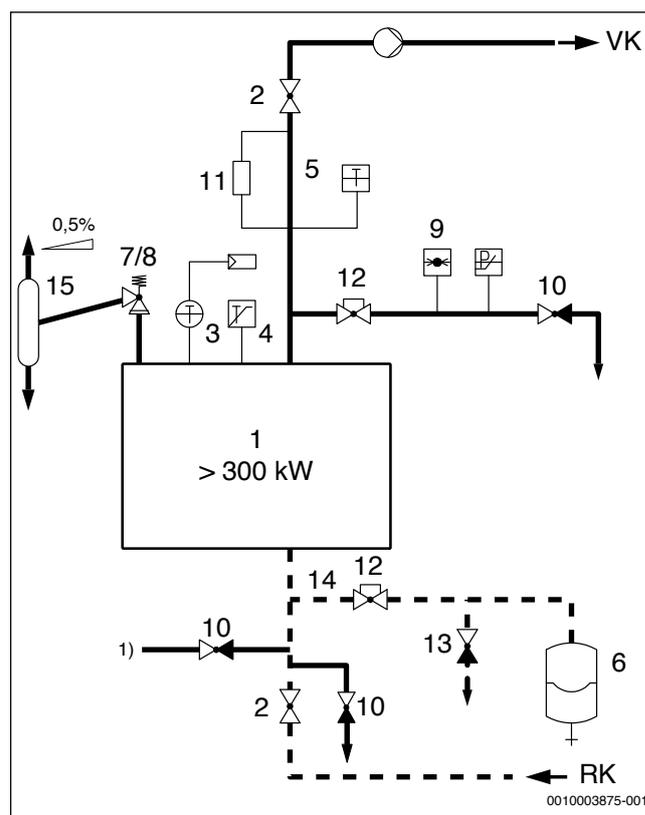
Equipaggiamento tecnico di sicurezza UNI EN 12828 per caldaia > 300 kW
